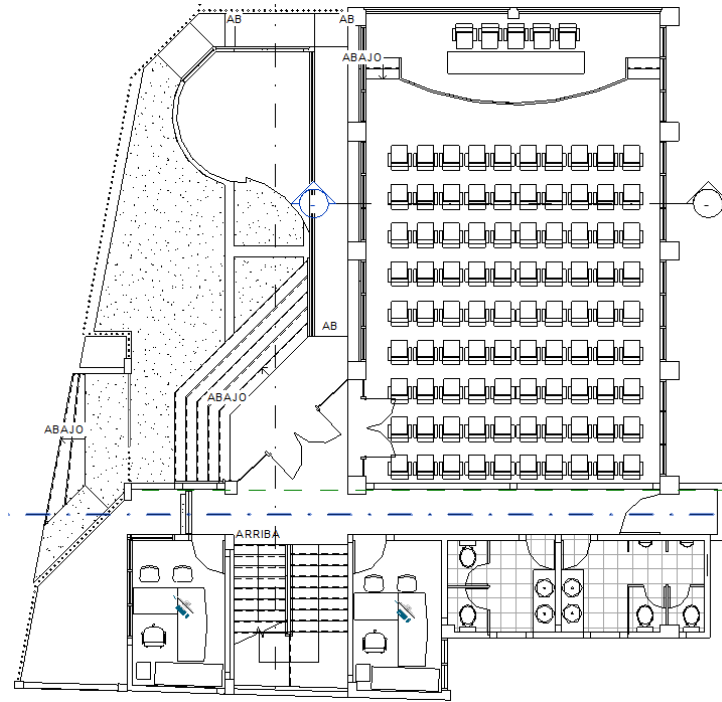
Plano de planta - Primer Piso. Fuente: Autor
